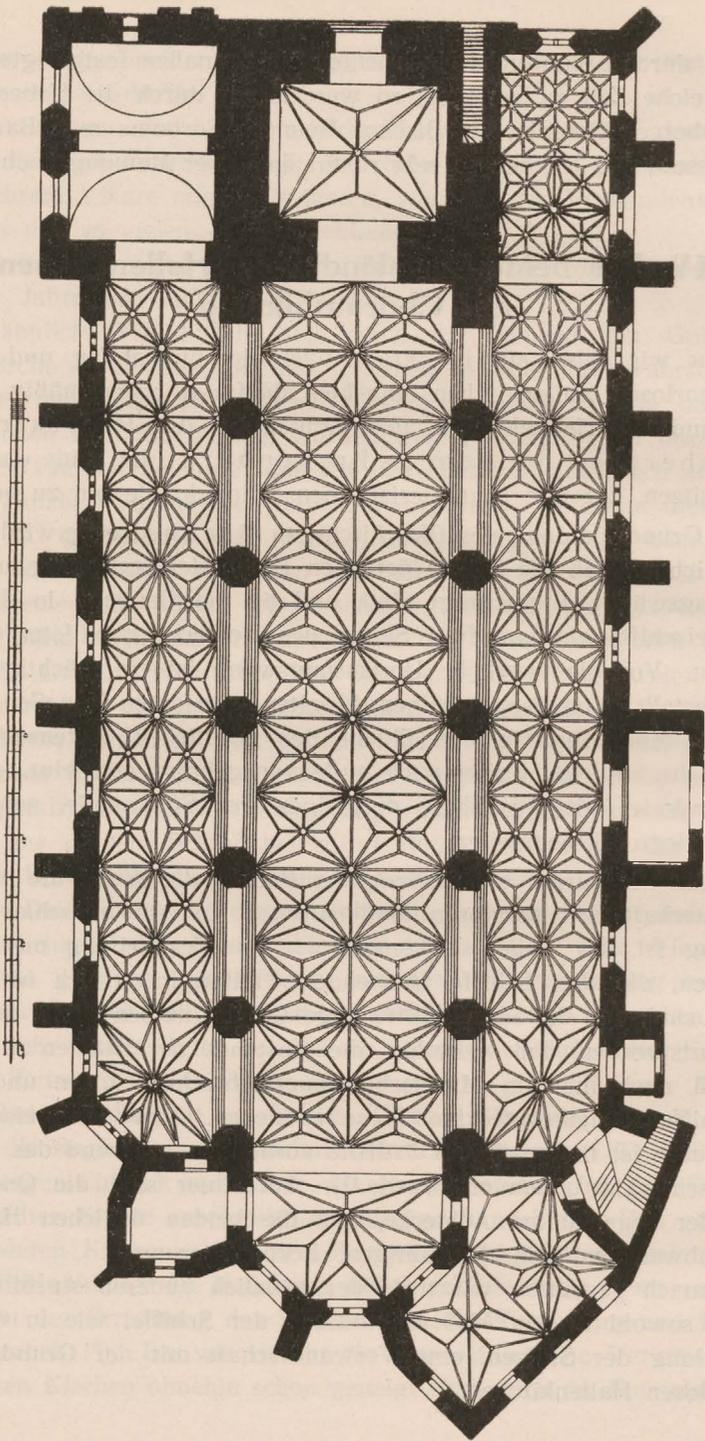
Pfarrkirche zu Braunsberg, Grundriß.
